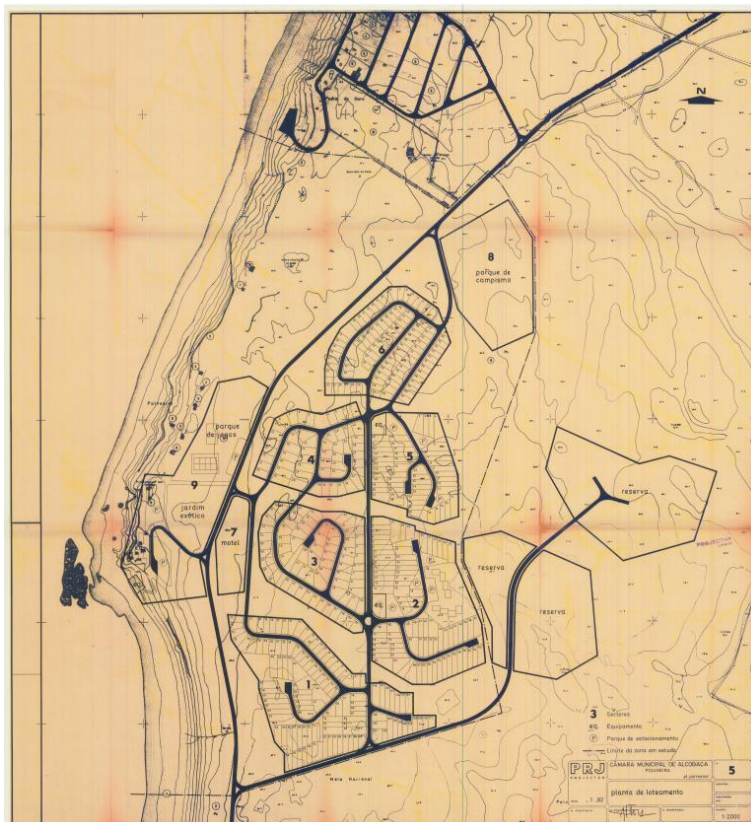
1º Plano de Pormenor da Polvoeira, 1981. Fonte: Câmara Municipal de Alcobaça
